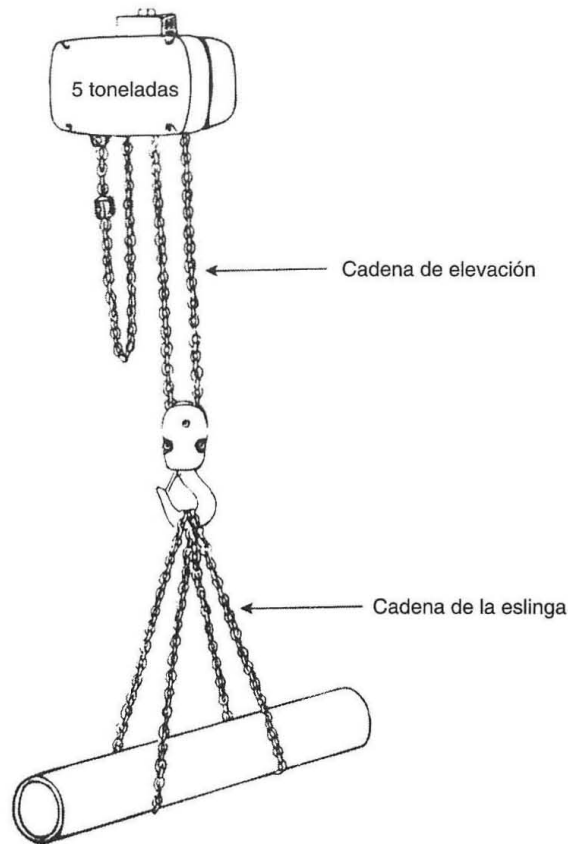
Elevador con eslinga. La cadena del elevador no debe confundirse con la cadena de la eslinga.
